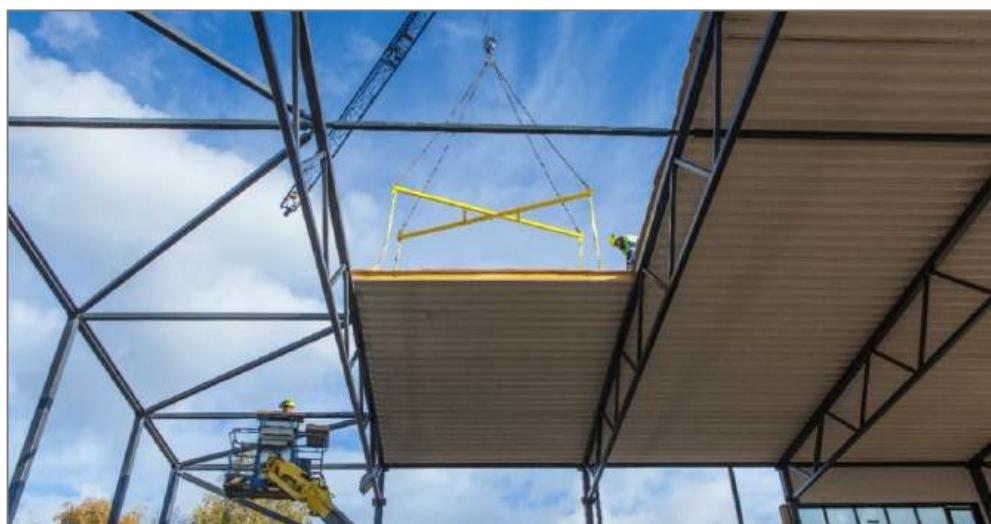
Exemple de système de toiture avec des panneaux sandwich de grande portée [31]
